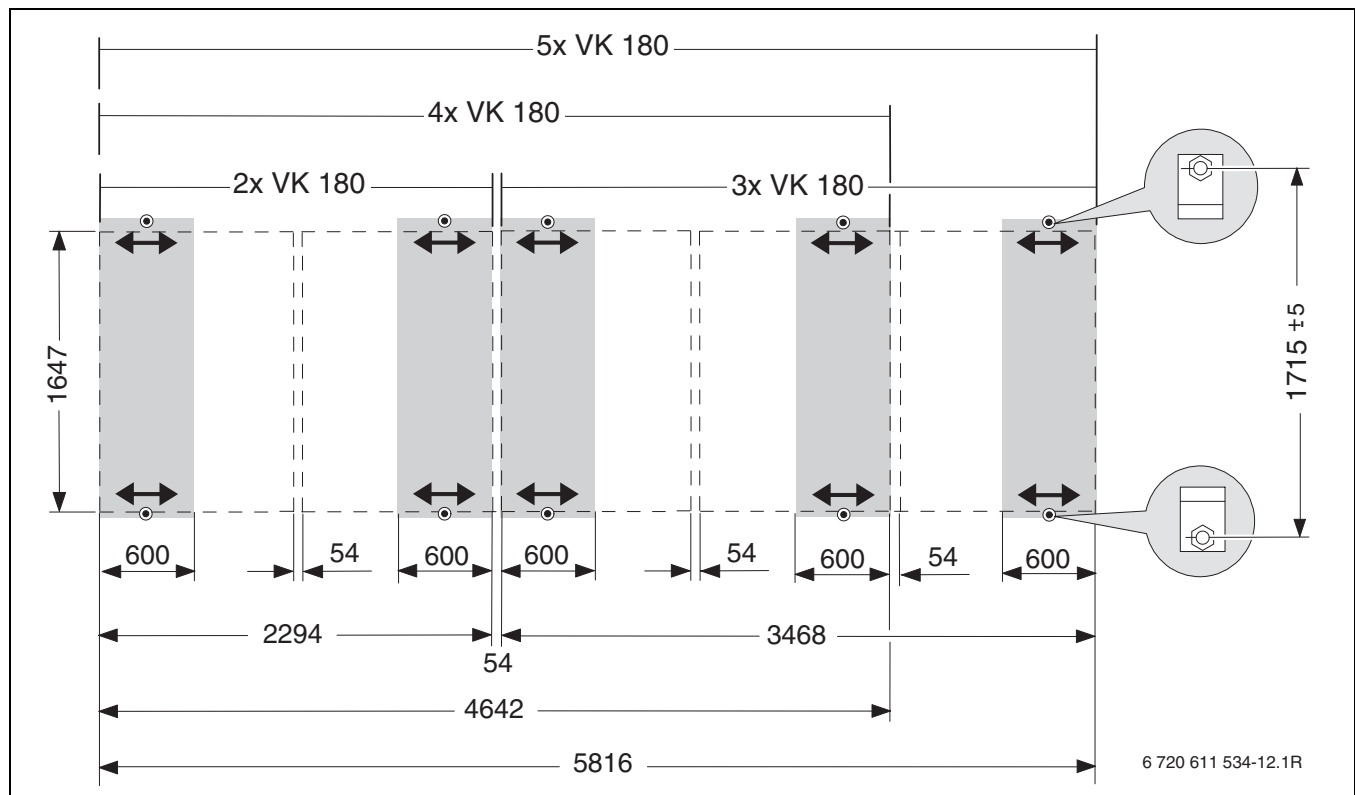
Vakuumröhren-Kollektorfeldmaße und Toleranzbereiche für die Befestigung der Stockschrauben
